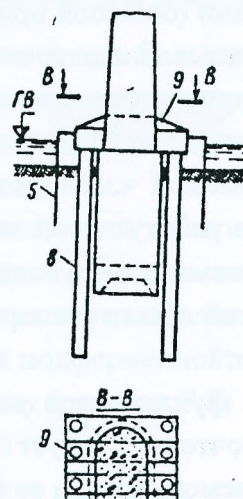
Усиление фундаментов на опускных колодцах: 8 – буровые сваи; 9 – железобетонные сваи (другие обозначения см. на рисунке 7.3).
